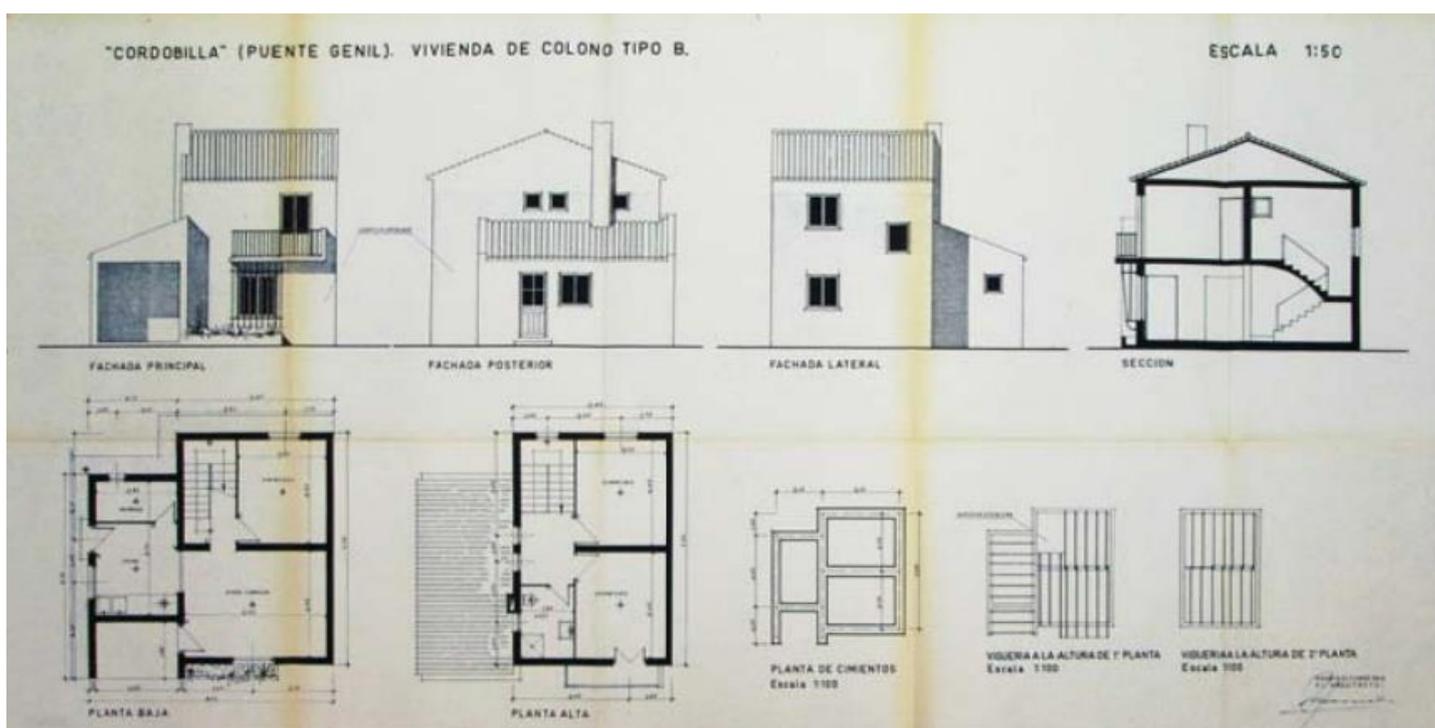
Planimetría general de vivienda de colono tipo B.
